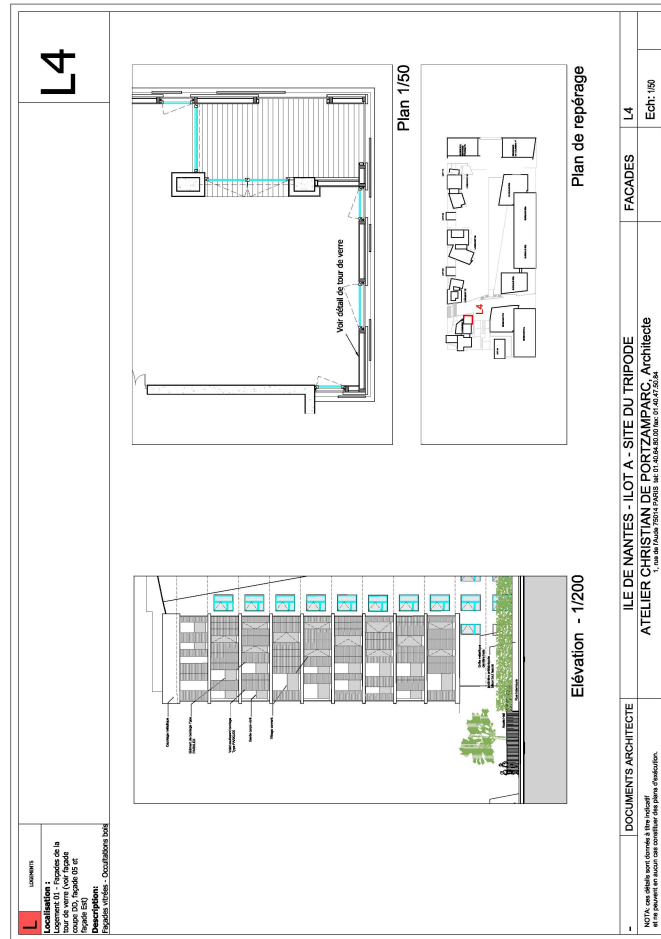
Les matériaux de la façade Nord du logement 2 et de la façade Sud du logement 4 à Tripode. Les façades sont construites en béton matricé avec des balcons qui sont en en béton lisse [de Portzamparc 10].
